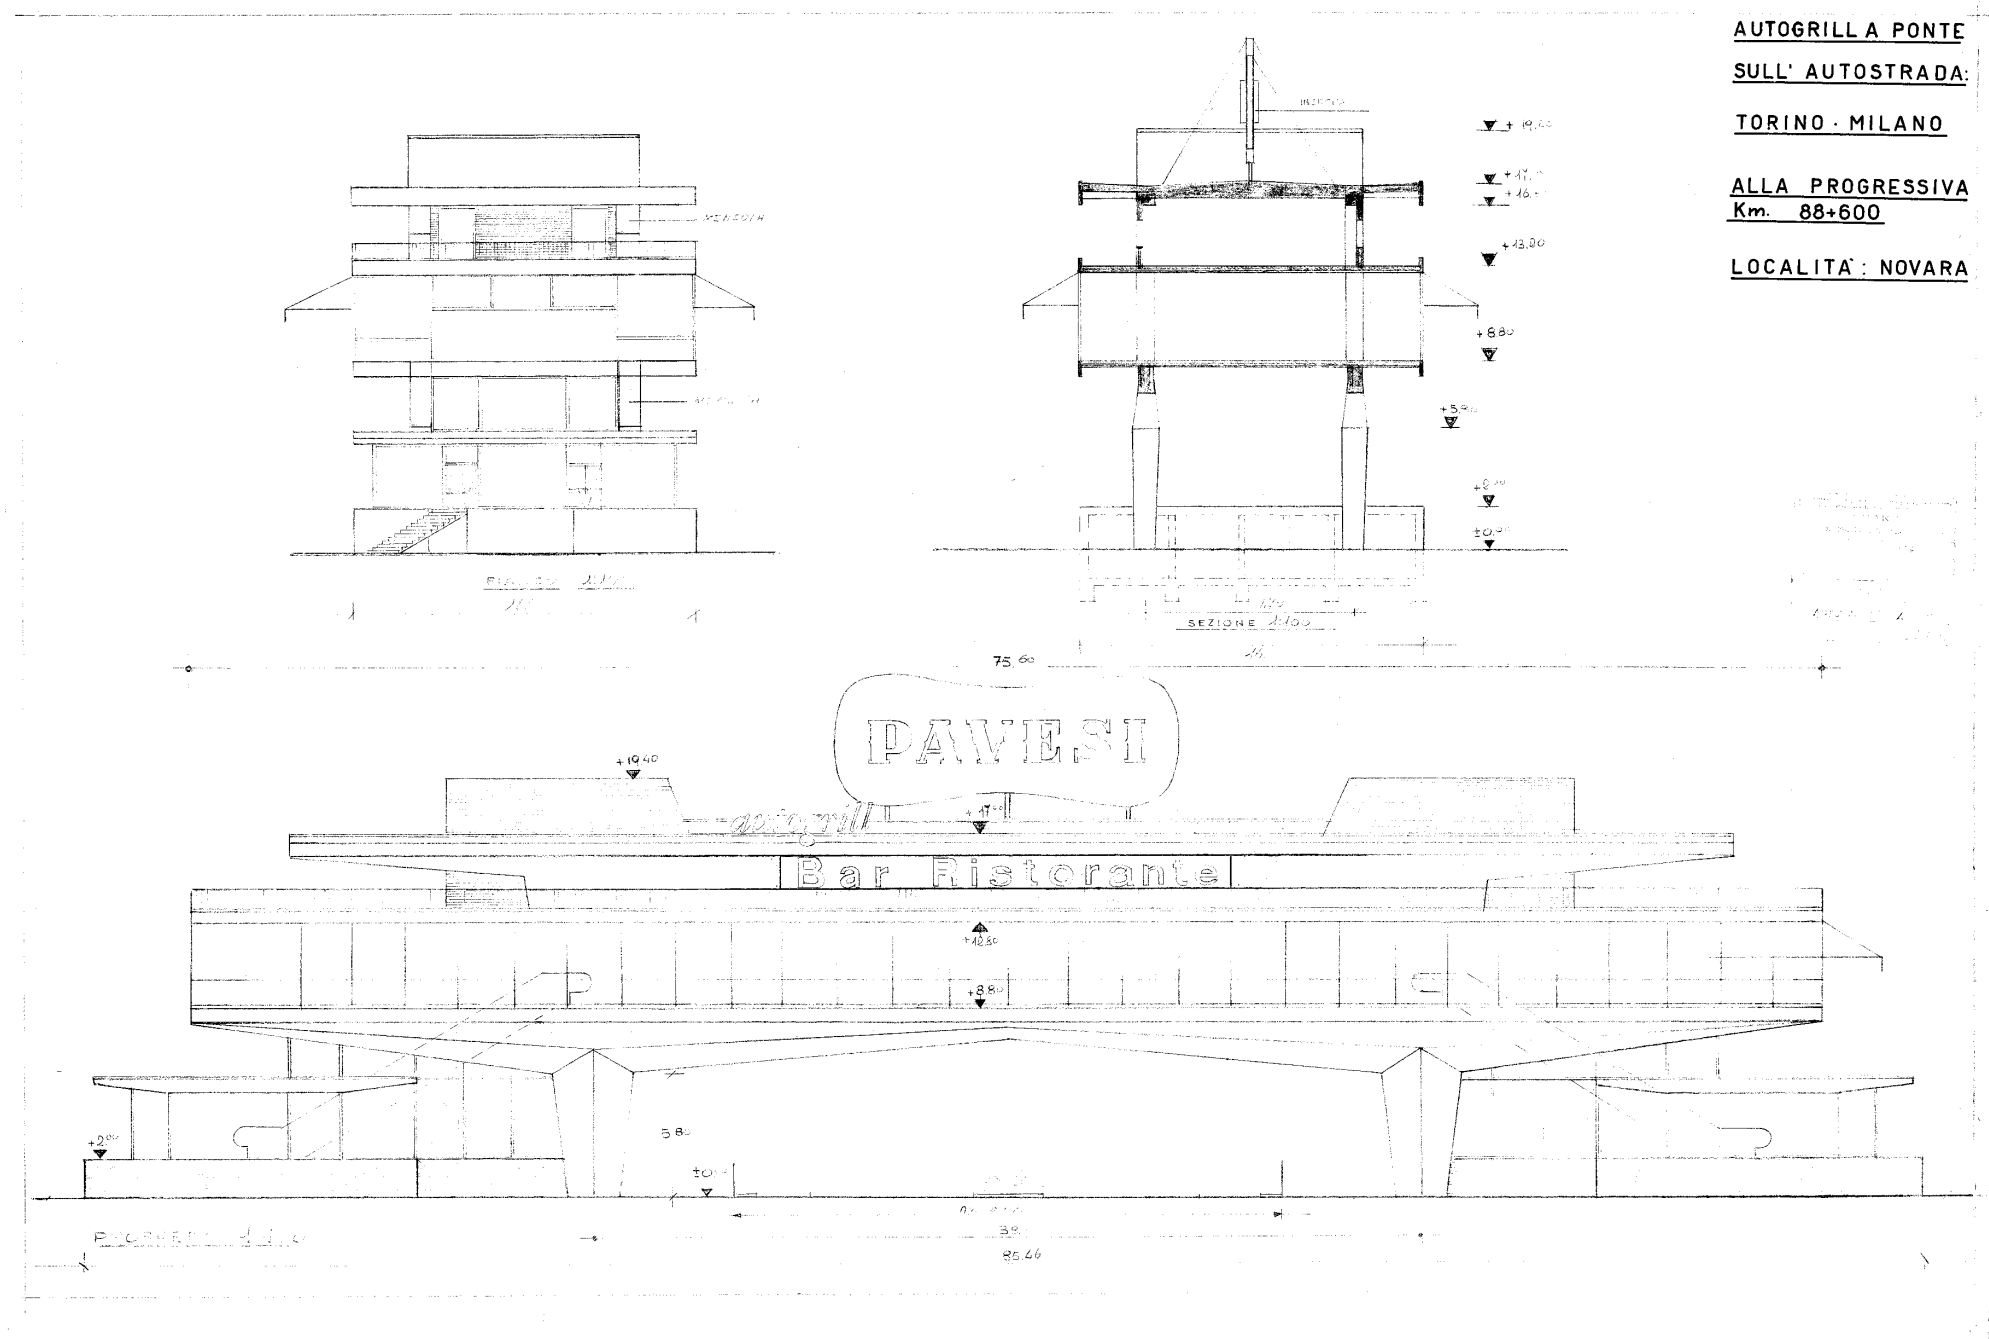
Prospetto laterale e sezione trasversale (in alto), prospetto sull'autostrada (in basso) (AAB)
